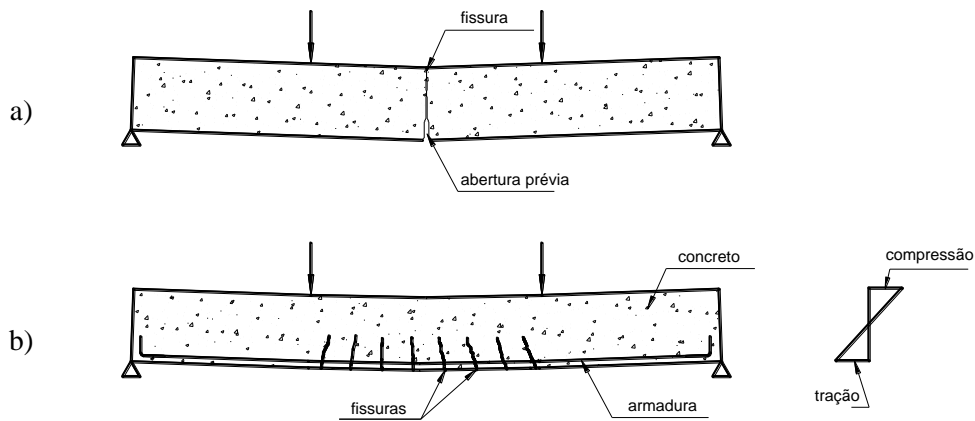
Viga de concreto: a) sem armadura; b) com armadura. (FONTE: PFEIL, 1989).
